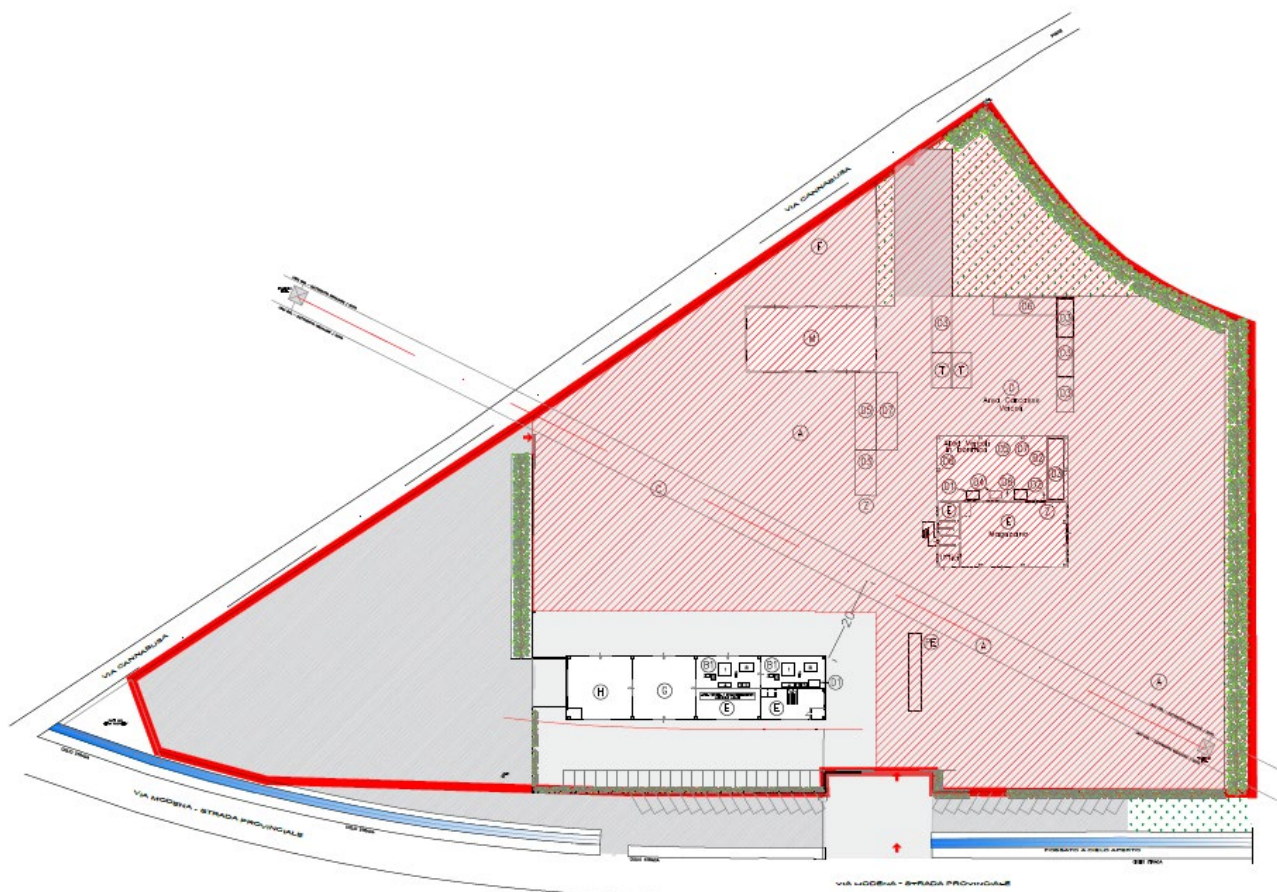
Stralcio Planimetria Stato di Progetto: dettaglio ampliamento (Tav.02)
